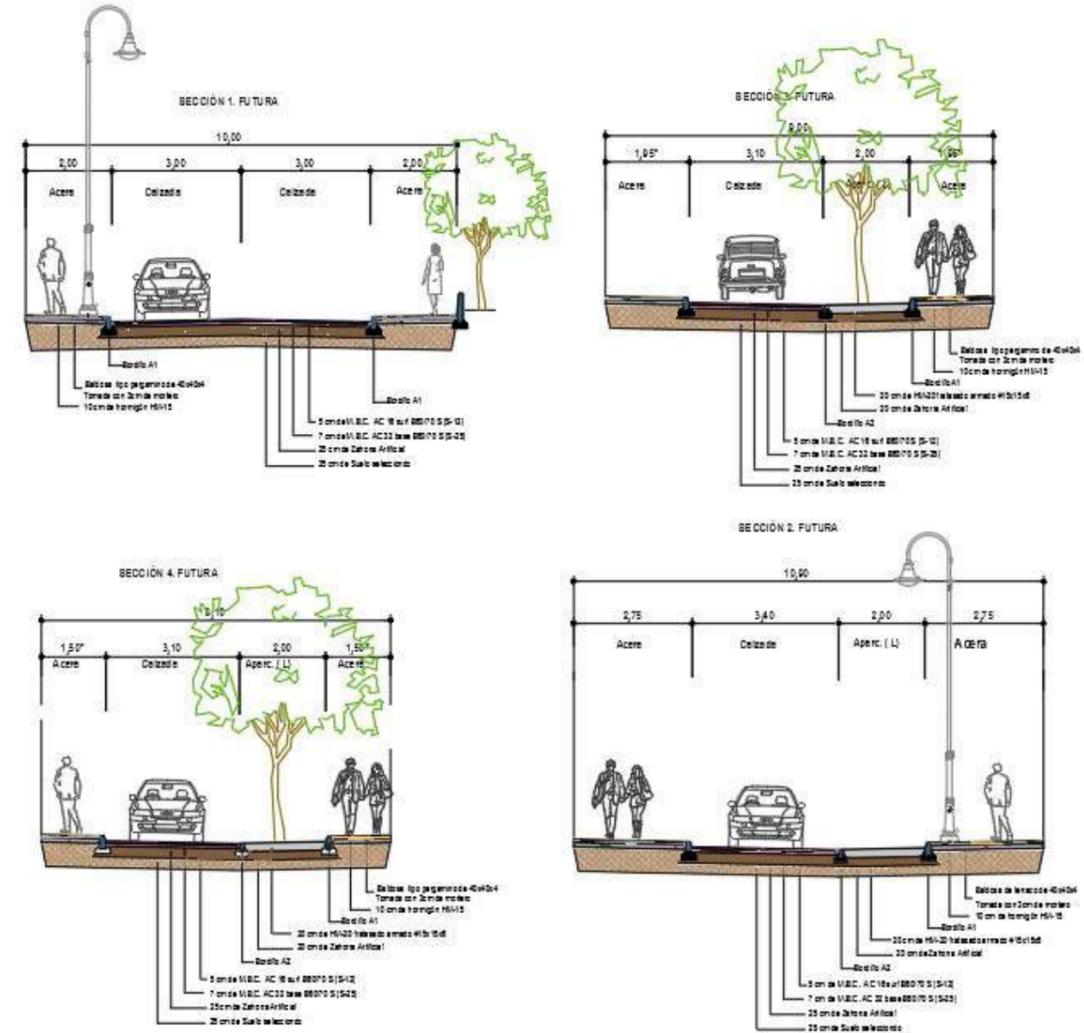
Detalle sección tipo 2. Definición de pavimentos
